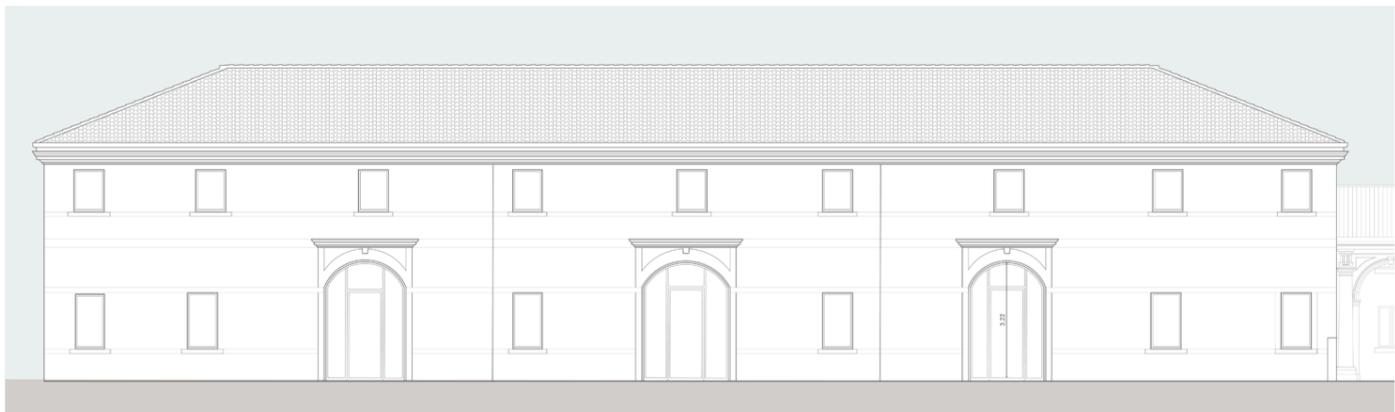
Prospetto ovest, rilievo geometrico, scala 1:200
